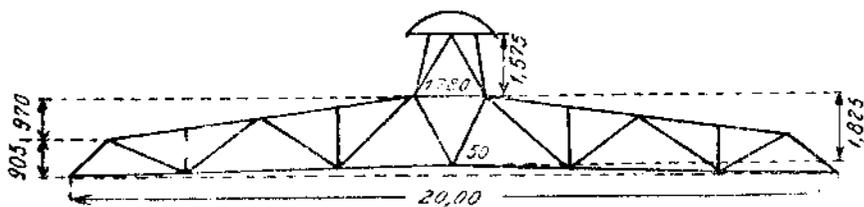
Металлическая стропильная ферма с шахтой для естественной вентиляции.
